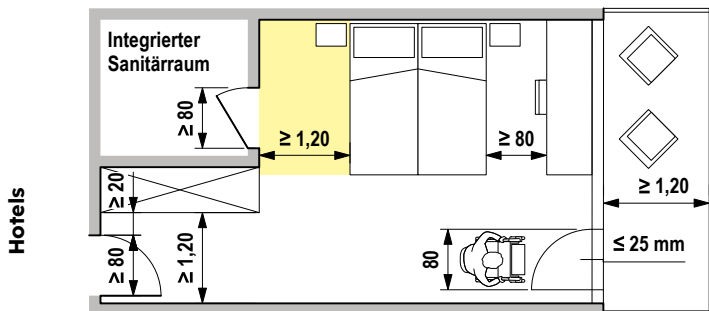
Beispielgrundriss eines Standardzimmers hindernisfrei mit integriertem Sanitärraum.
